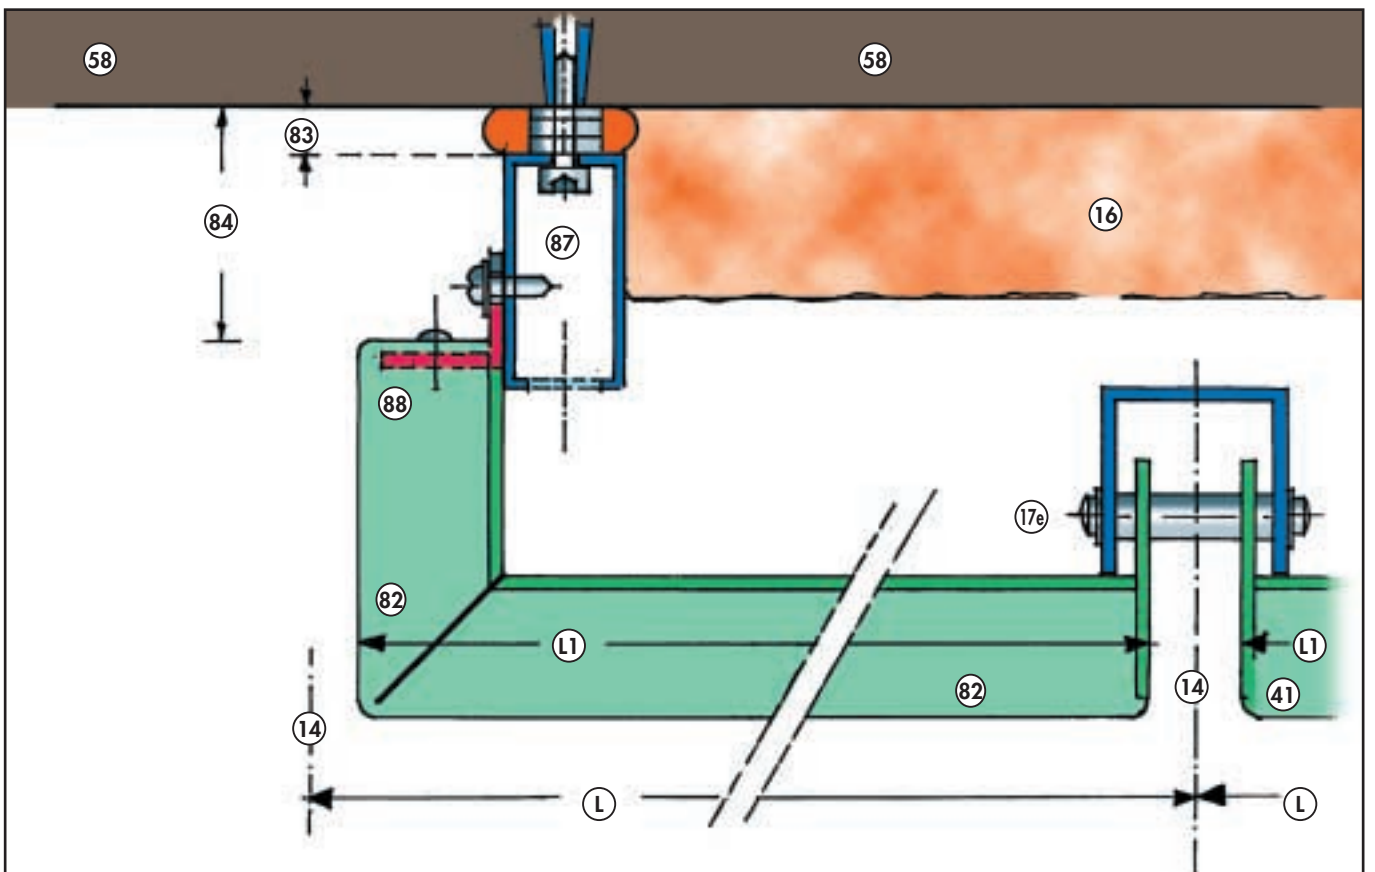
c) - Sezione orizzontale delle soluzioni G, J
